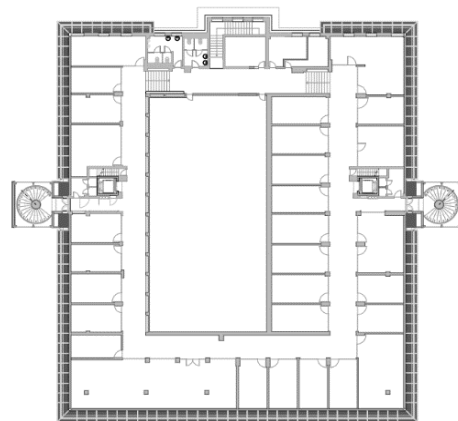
Planta Piso 3, Centro comercial Girasolum.
